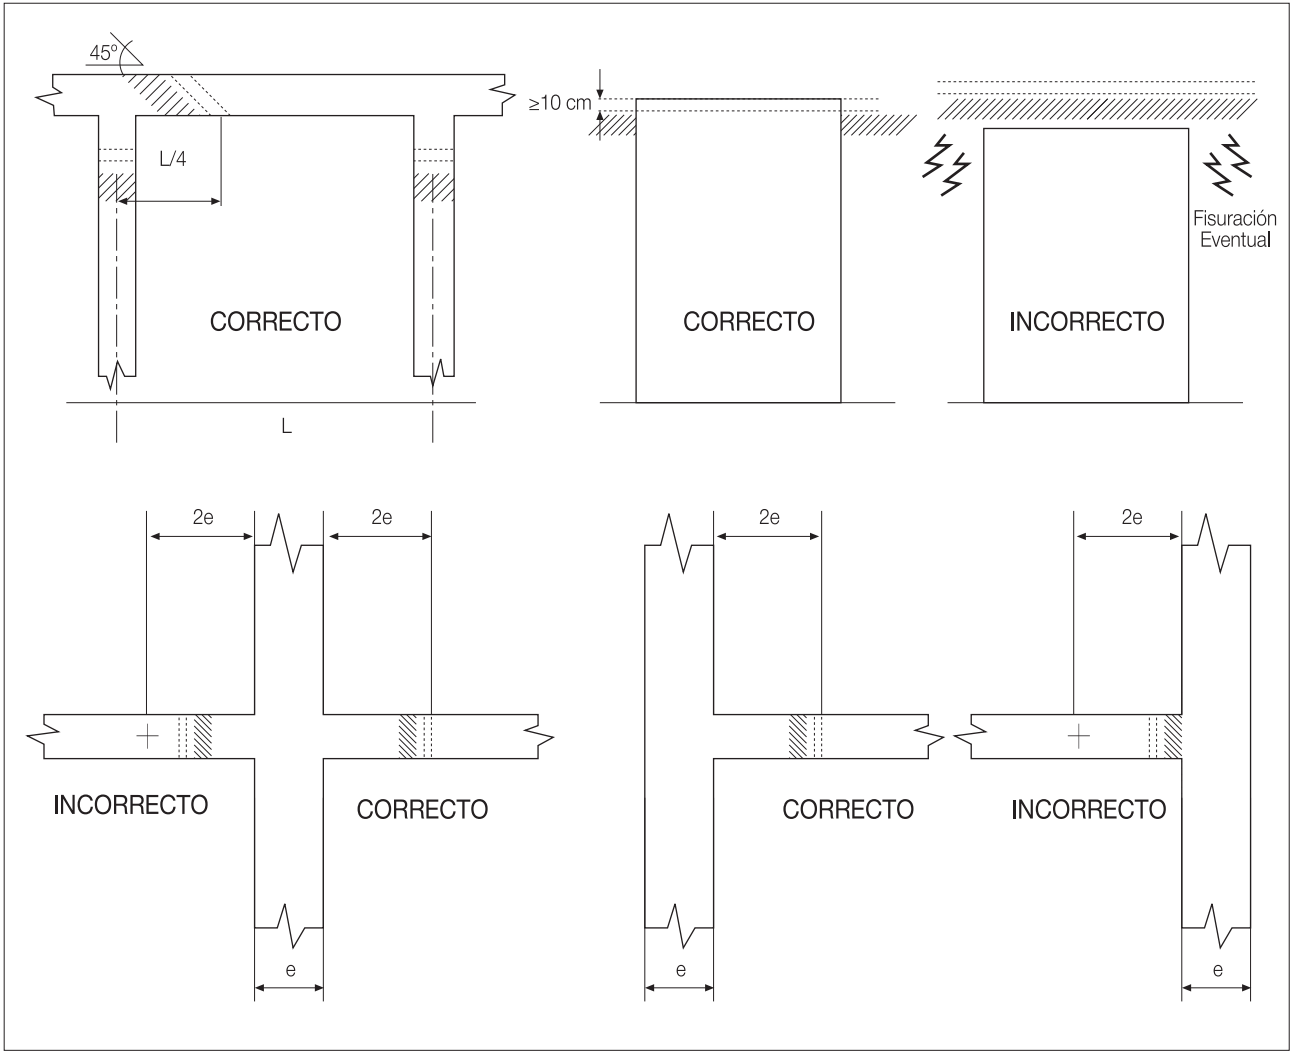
1b: Ubicación de las Juntas de Hormigonado Losas y Vigas, Vanos de Muros y Cruces y Encuentros de Vigas
